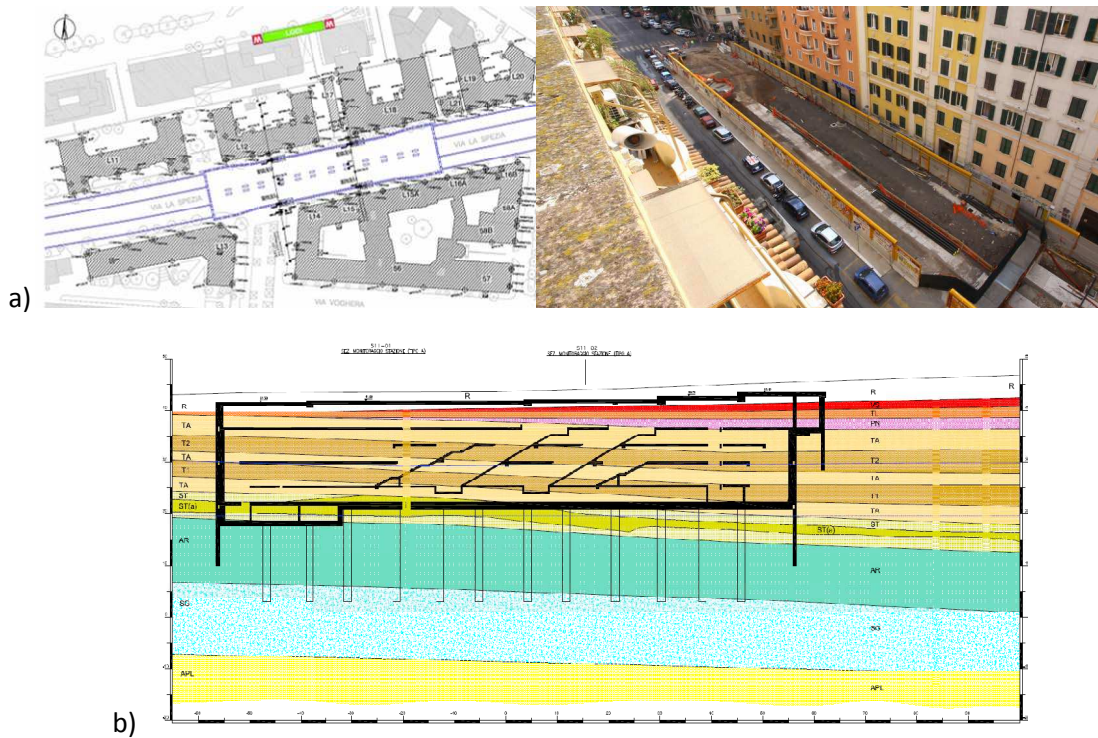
Stazione Lodi: a) Planimetria e veduta di insieme b) Sezione geotecnica longitudinale
